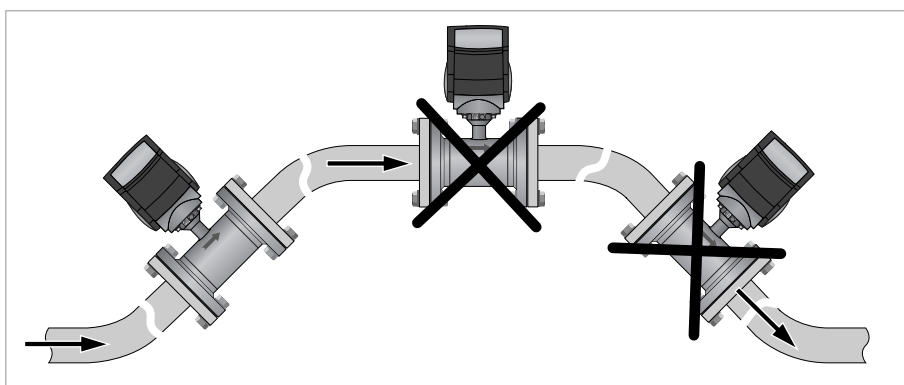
Монтаж в изогнутых трубопроводах
